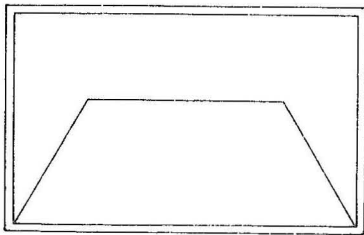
Fenêtre à vantail sur axe horizontal inférieur (ouvrante vers l'extérieur)
